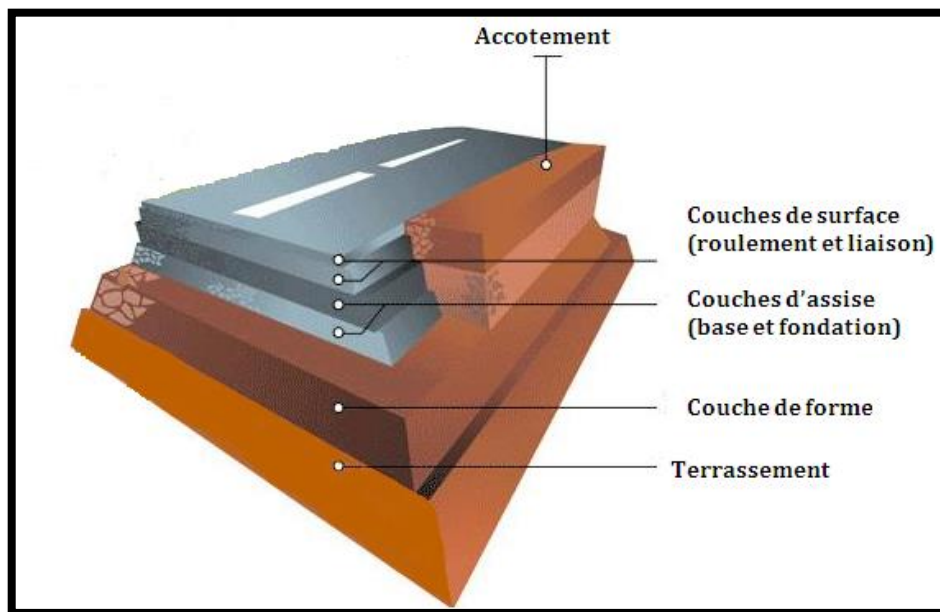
Les différentes couches qui constituent la structure de la chaussée.
